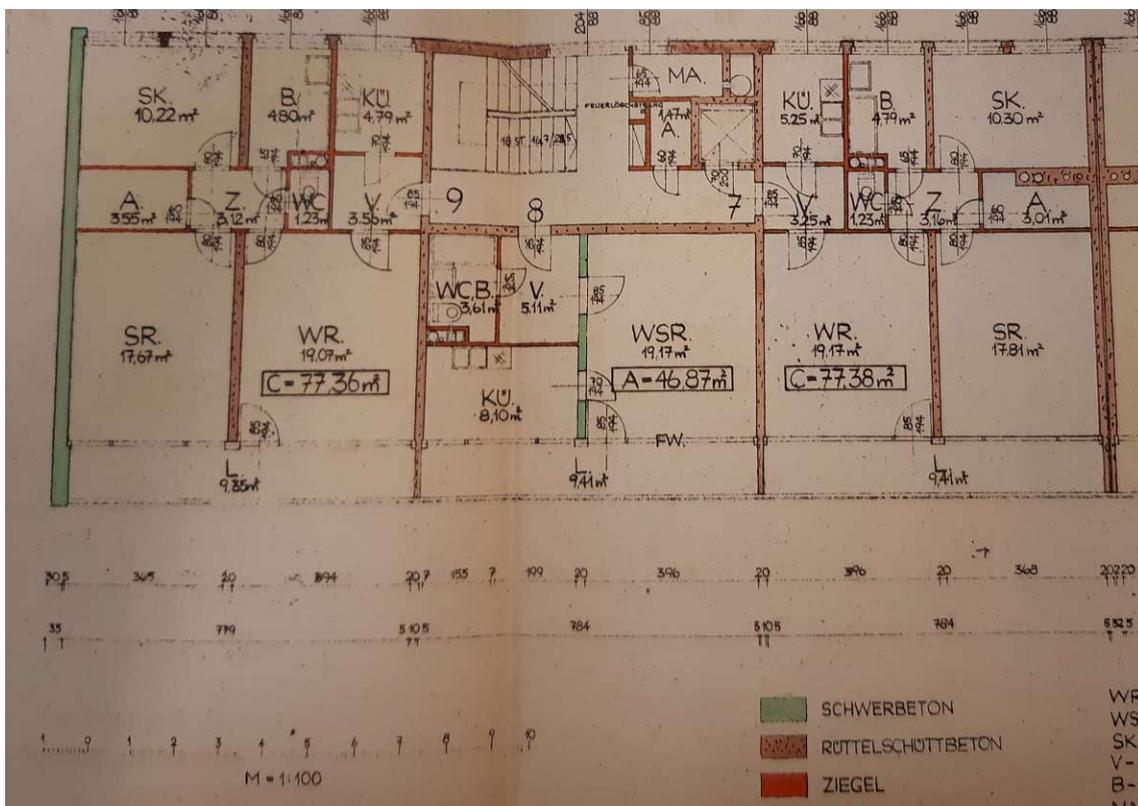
Vorgartenstraße 158-170, Stiege 1 - Grundriss 2.OG
